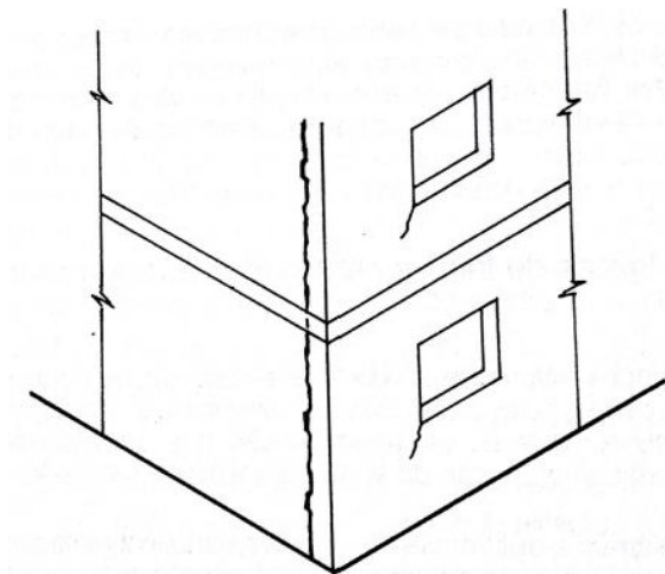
Fissura causada por fundações excessivamente flexíveis
